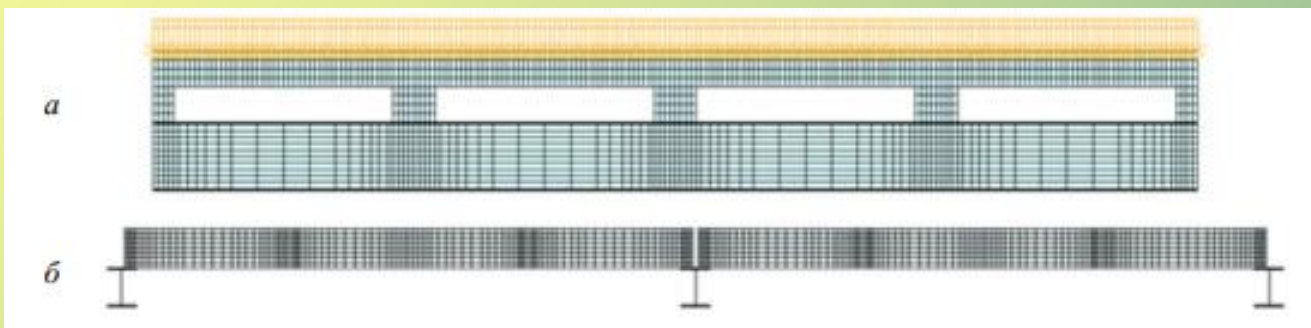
Досліджувана чисельна модель фрагменту перекриття:
